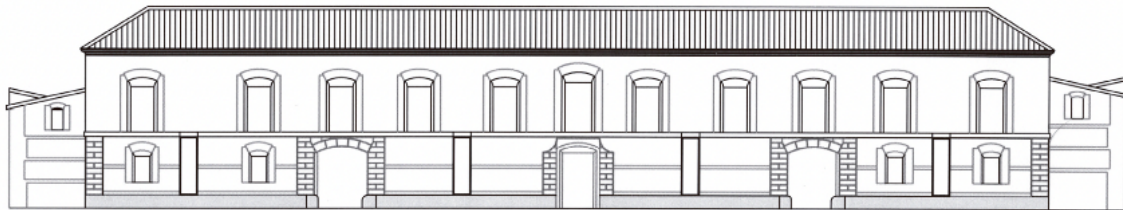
Alzado de la fachada principal de la posada de Librilla donde se aprecia la simetría de la misma.
